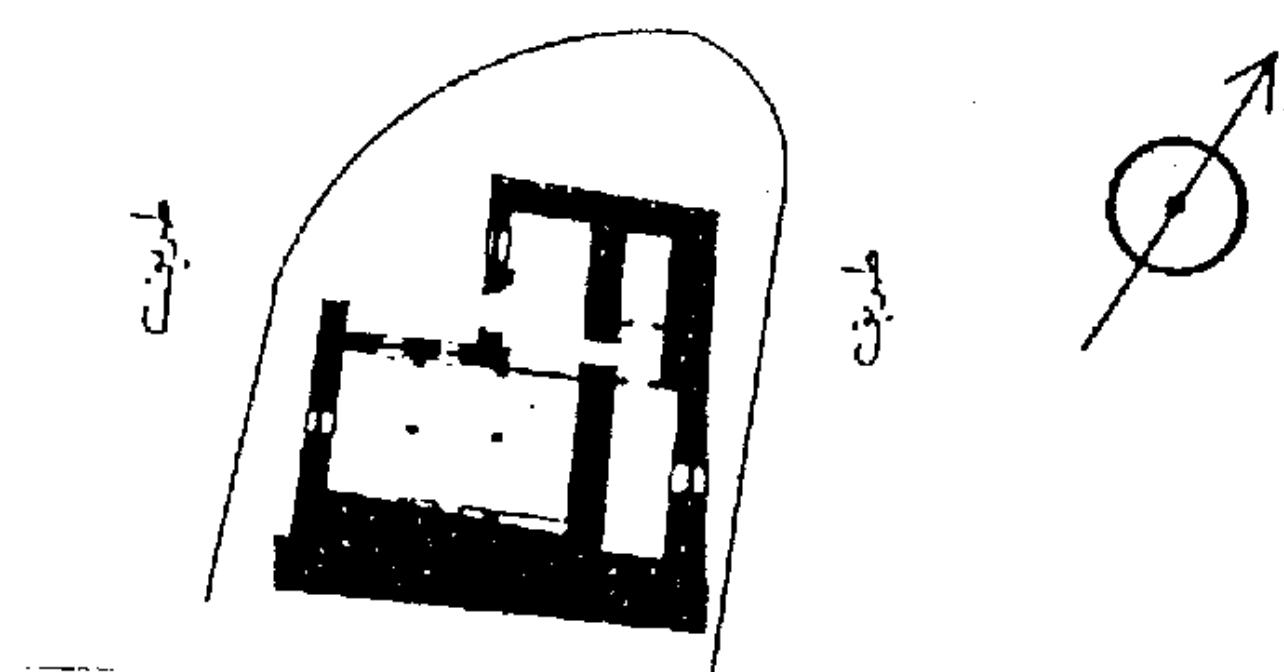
مسقط أفقي لجامع الناقه عن الموسوعة (الجزء الأول).
